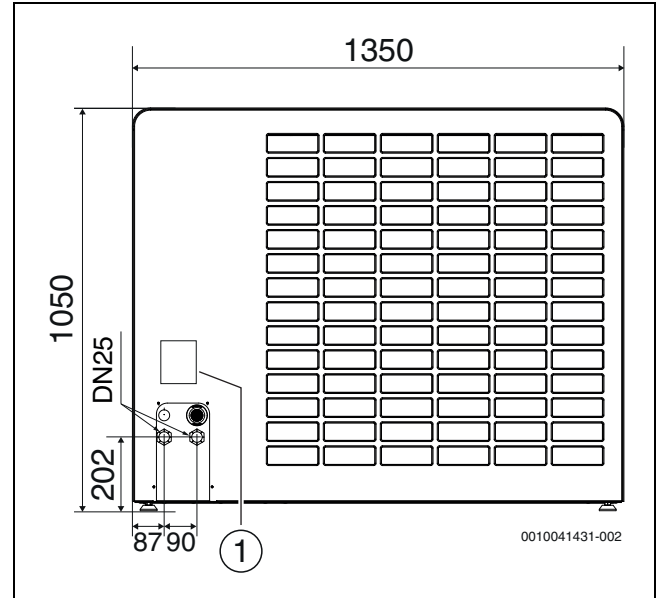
Dimensions et raccords de la pompe à chaleur, arrière
